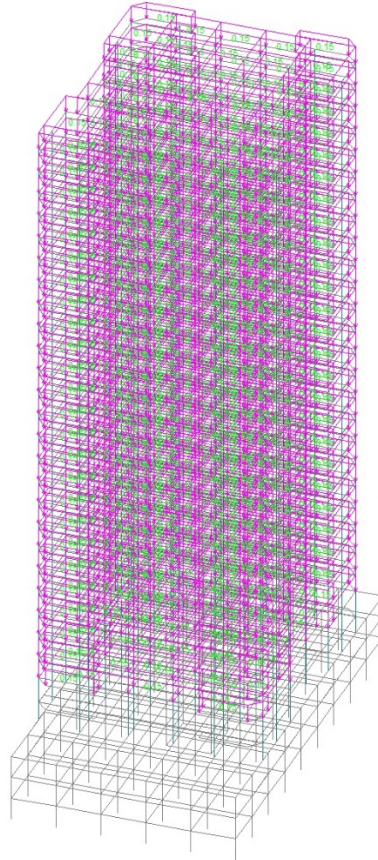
Длительная нагрузка от жилых квартир
